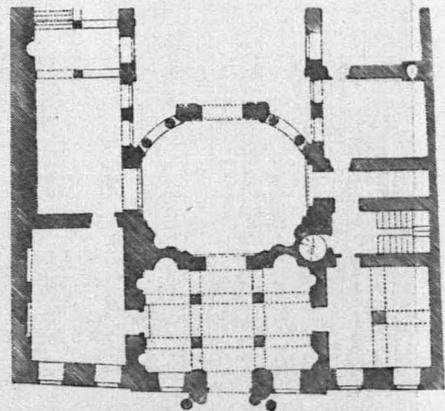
Grundriß der Eingangshalle des Daunschen (jetzt Kinskyschen) Palastes in Wien, nach Alb. Niemann, s. nebenan
